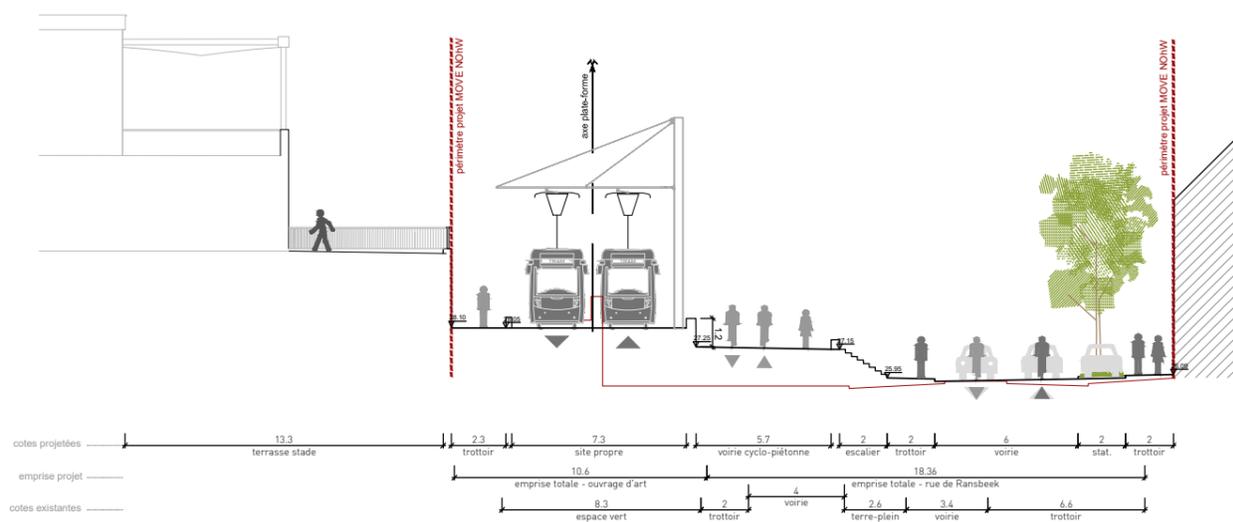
Urbanisme - Chemin Vert - Vue en coupe en travers au niveau du stade
